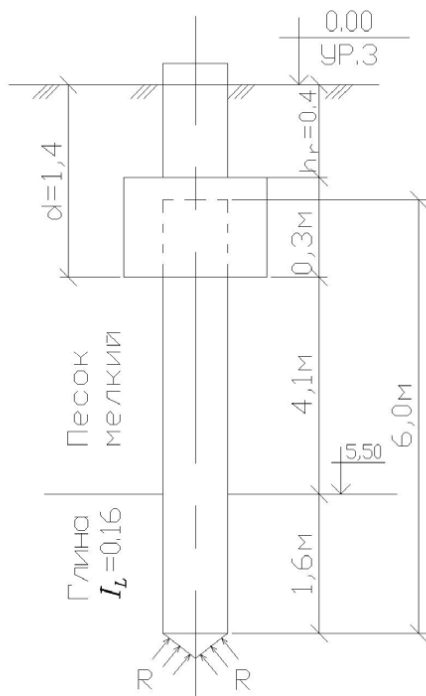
Схема размещения сваи-стойки в грунтах основания
